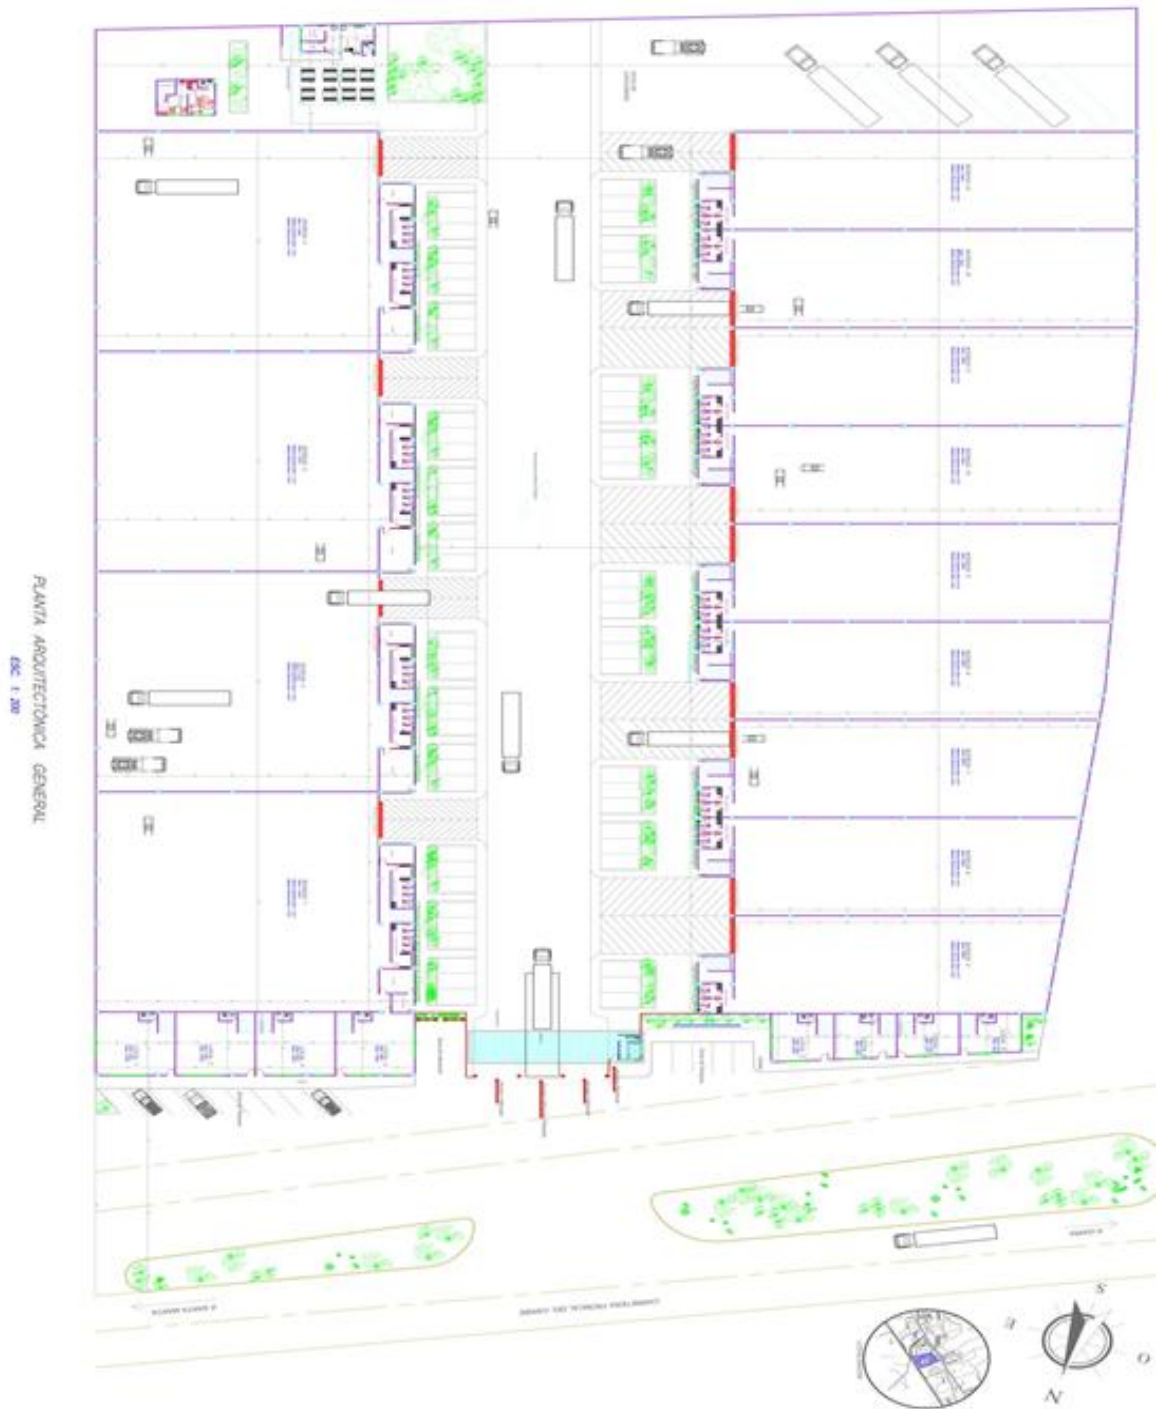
Planta Arquitectónica Parque Industrial el Sol
